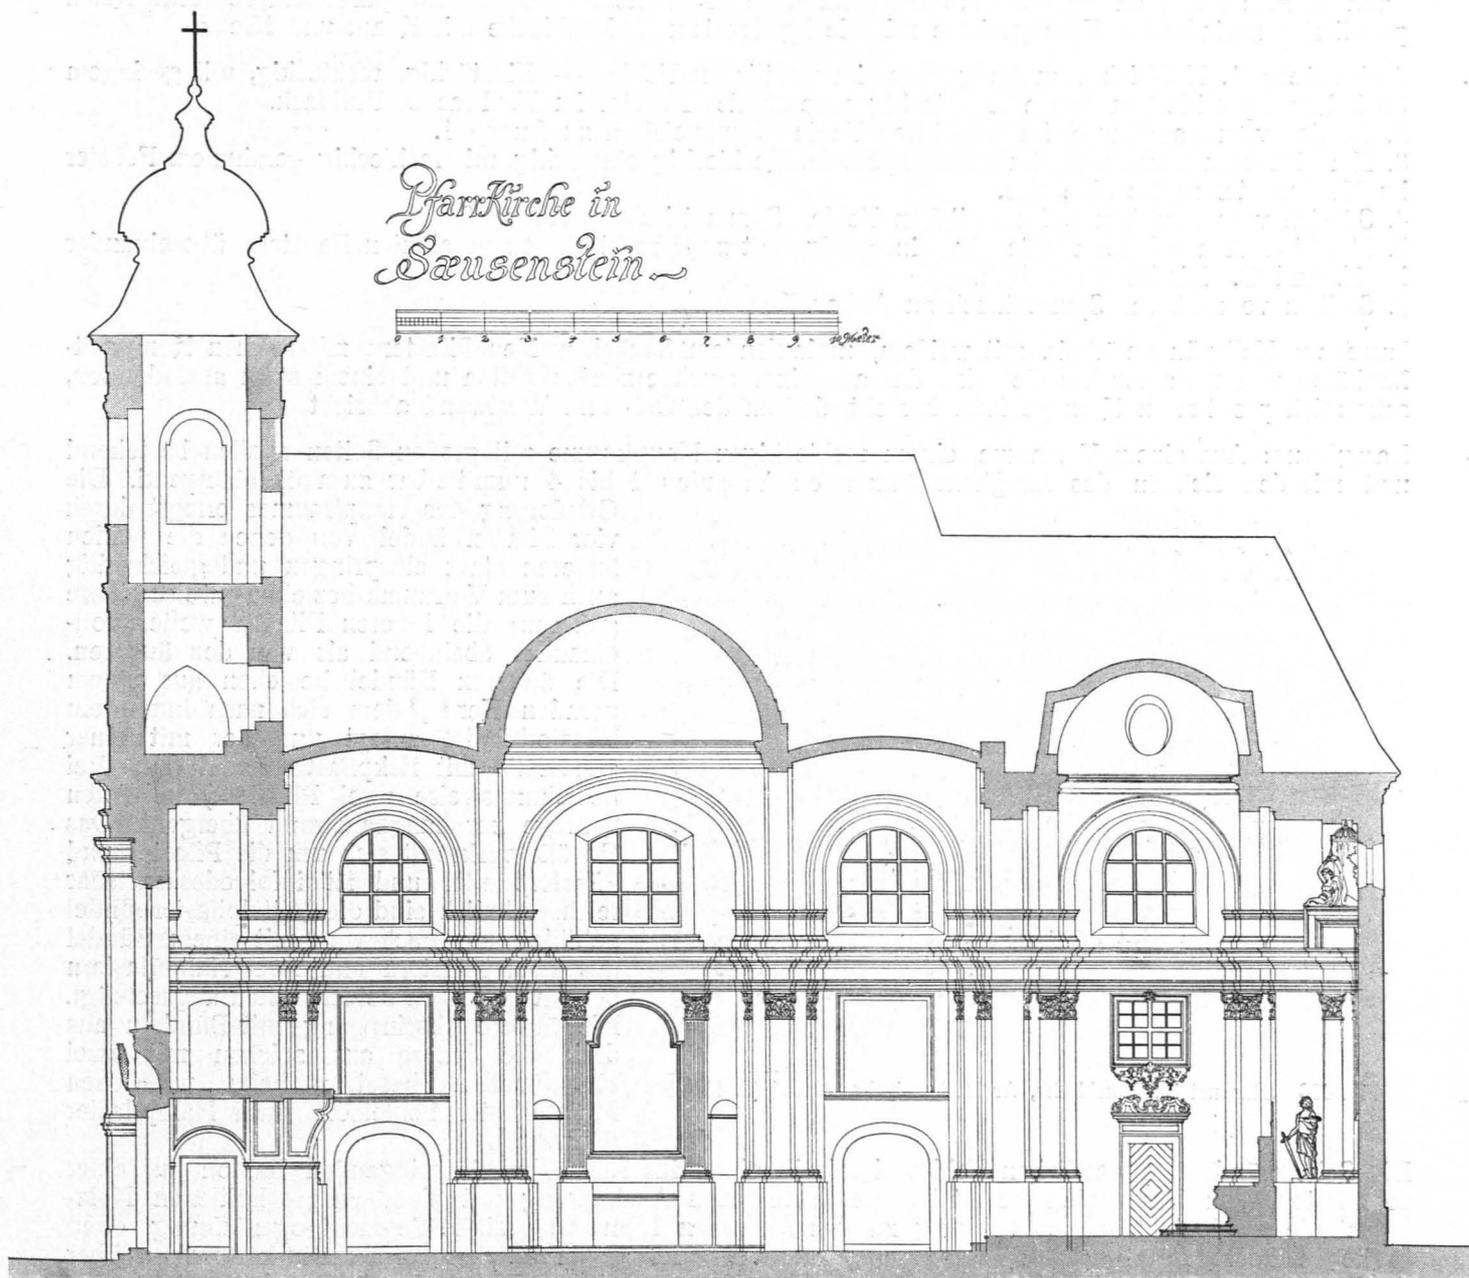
Säusenstein, Pfarrkirche, Längsschnitt (S. 406)
